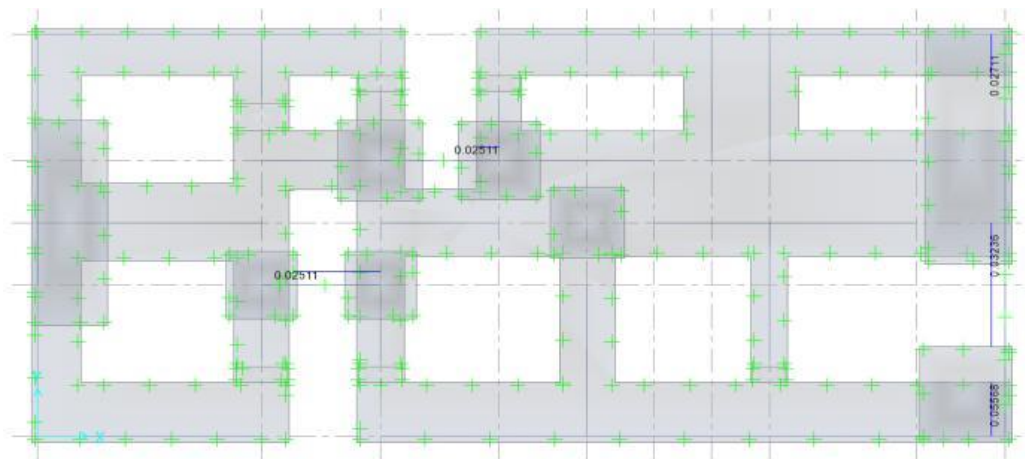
Distribución de acero por Cortante en las Vigas de Cimentación (cm²/cm)
